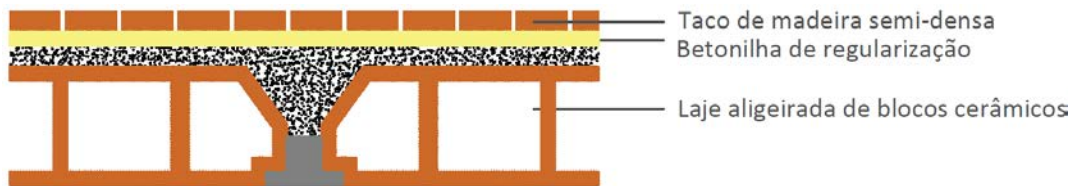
Solução construtiva tipo de pavimento sobre desvão sanitário – Pós intervenção
